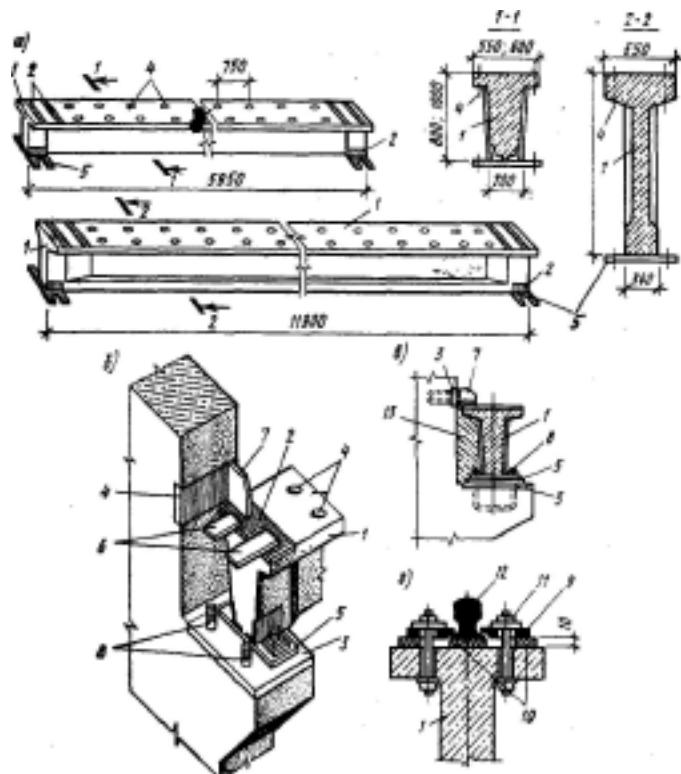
Типы, опирание и крепление подкрановых балок и рельса:
